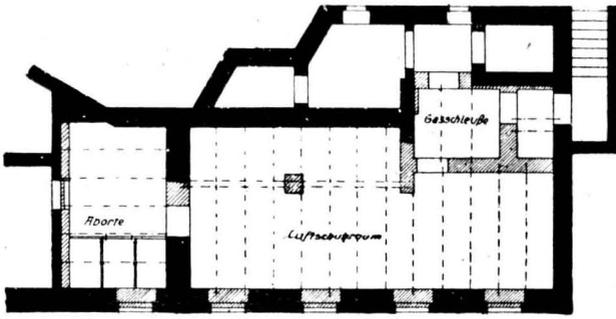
Grundriß eines Luftschutzraumes mit eiserner Trägerlage.
